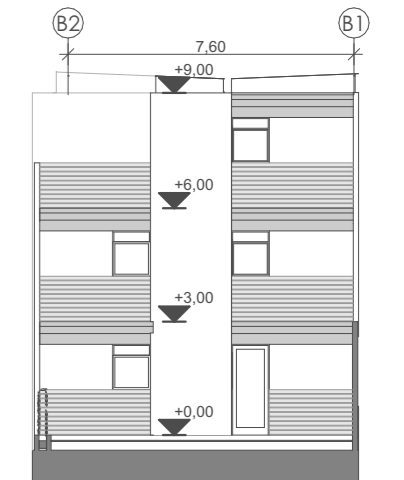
Alzado lateral izquierdo del Bloque B (BI) Elaboración propia (2026). Escala 1:200
